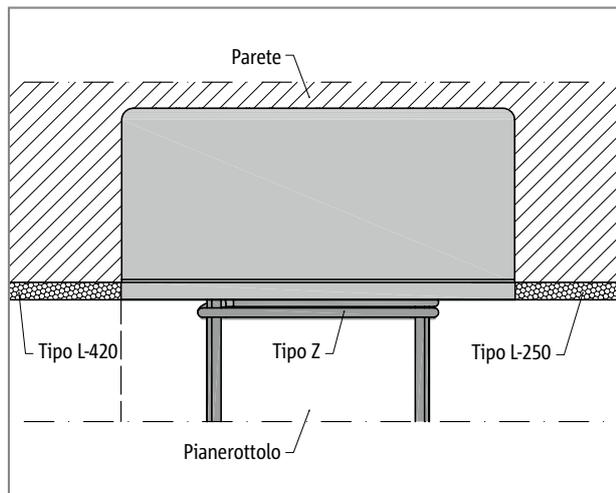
Schöck Tronsole® tipo Z, disposizione dell'elemento; dettaglio A
